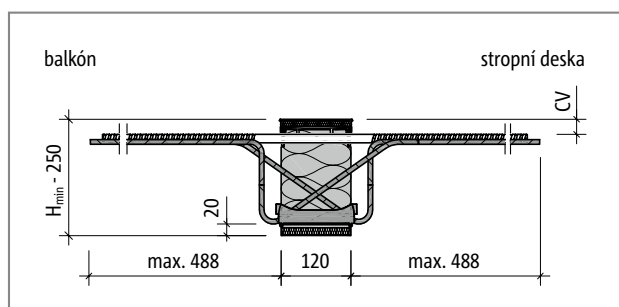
Schöck Isokorb® CXT typ KL-M6-V2: Řez prvkem
